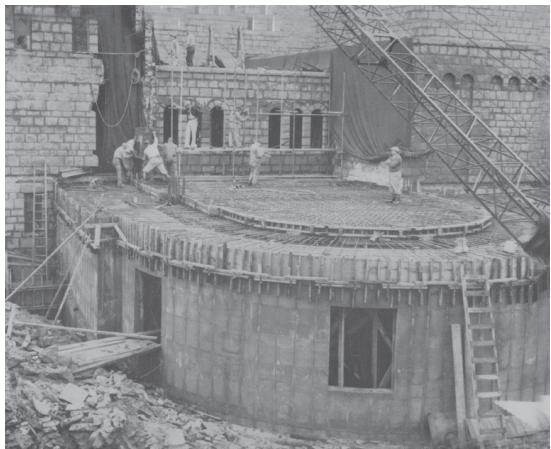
Construcción del basamento en hormigón armado sobre el que reconstruir el ábside de Fuentidueña. Se observa el replanteo de las primeras hiladas.
